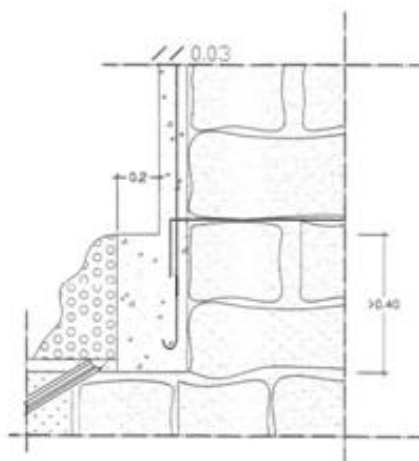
20 Pormenor de ligação do reboco à fundação, [37].
